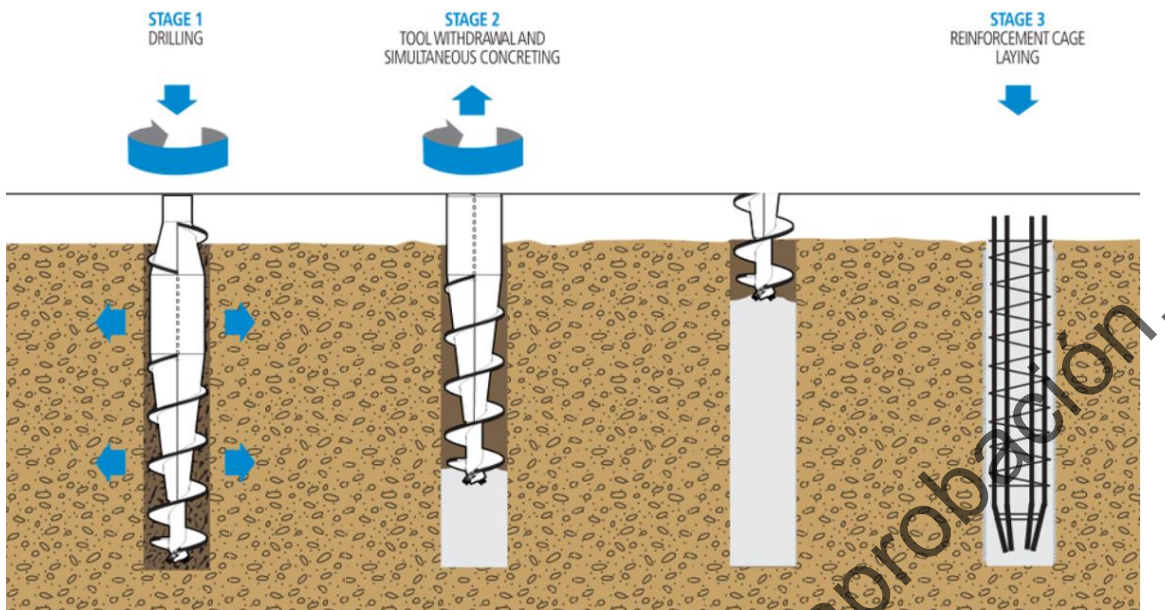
Esquema de pilote de desplazamiento sin excavación.
